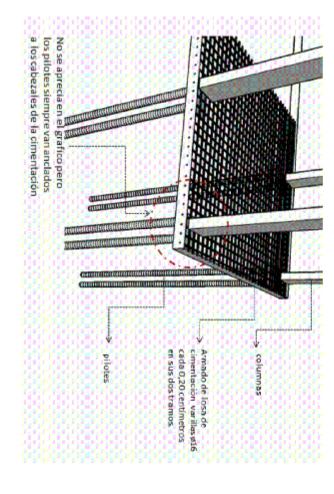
Esquema losa de cimentación. Fuente: Jaime Dávila, 2015
